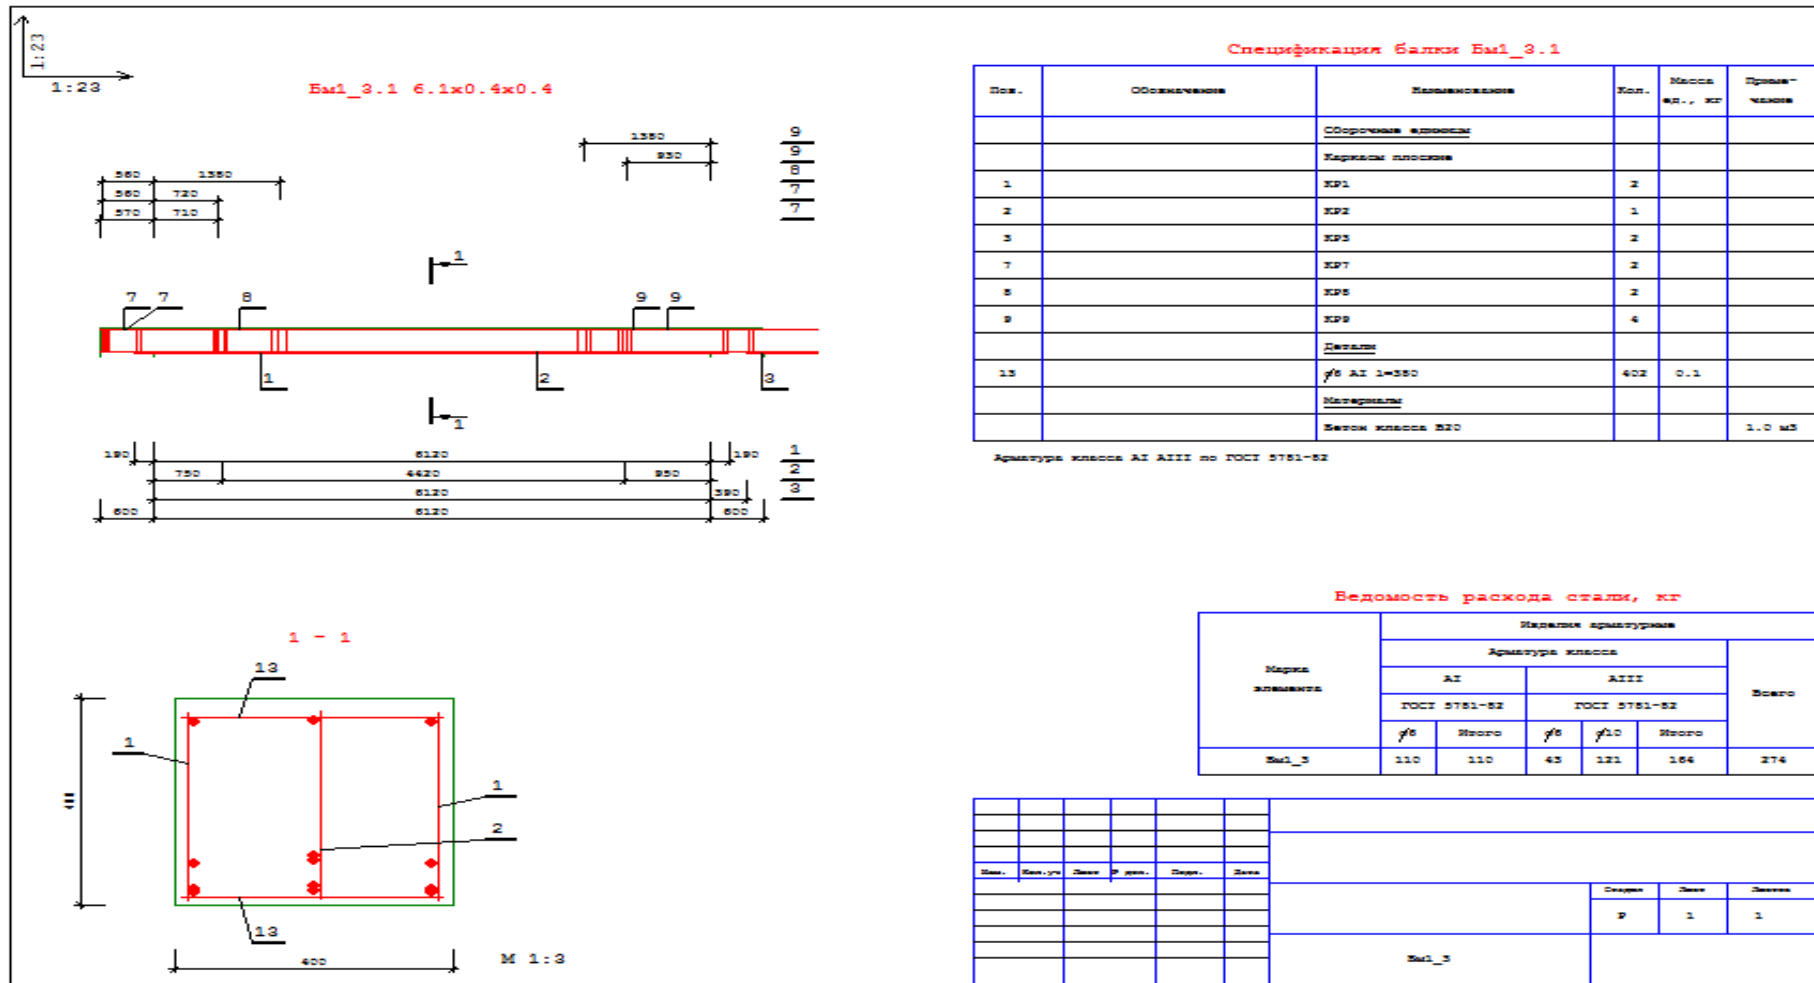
Варіант будинку з балочно - плитним перекриттям. Балка Б1-3. Креслення робочого проекту
